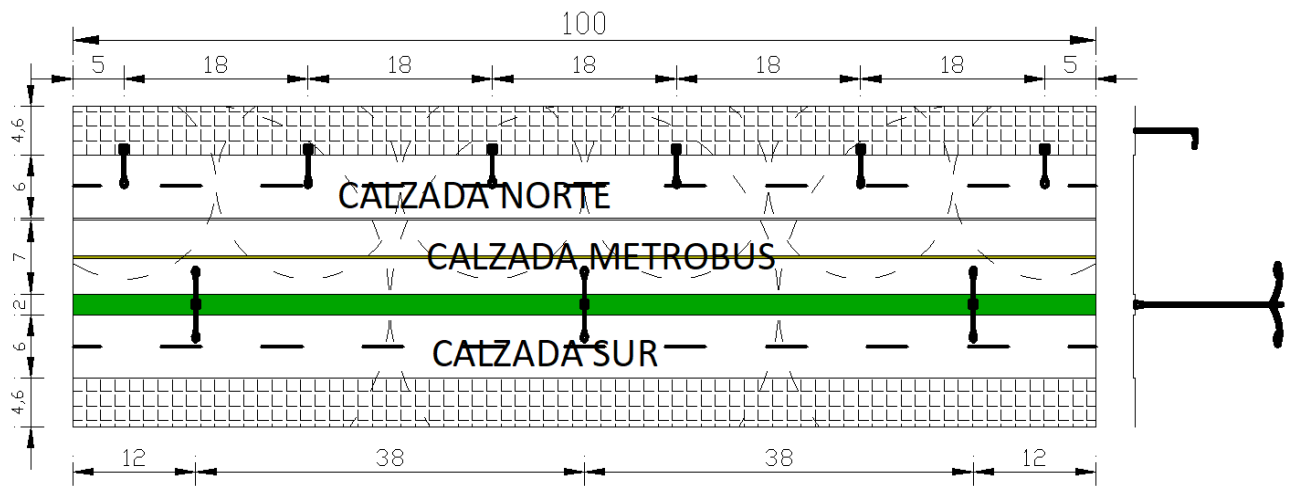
Detalle disposición de luminaria cuadra tipo N°1. (Fuente: elaboración propia)
